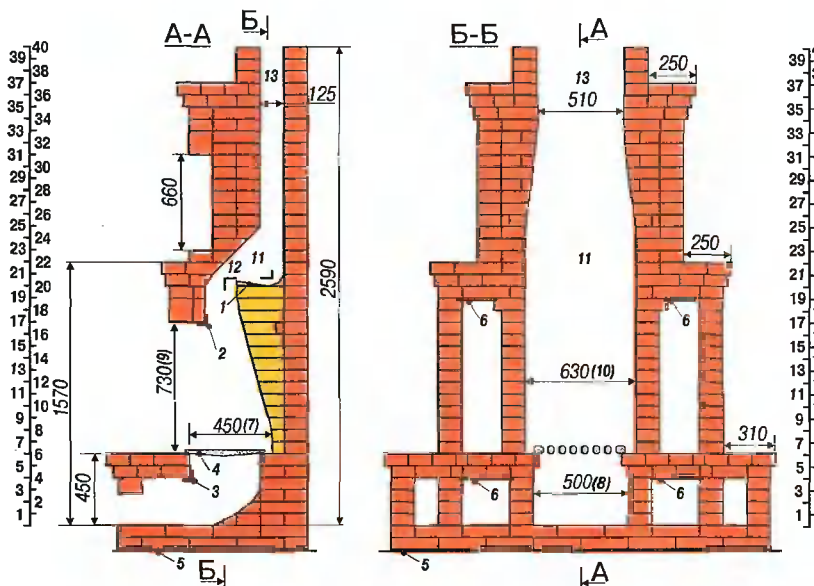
Вид камина по разрезам А-А и Б-Б: 1 — газовый порожек; 2 — уголок №60; 3 — уголок №40; 4 — колосники; 5 — гидроизоляция; 6 — пластина 3х10 мм; 7 — глубина топливника; 8 — ширина поддувала; 9 — высота проема топливника; 10 — ширина топливника; 11 — дымосборник; 12 — хайло; 13 — дымоход
